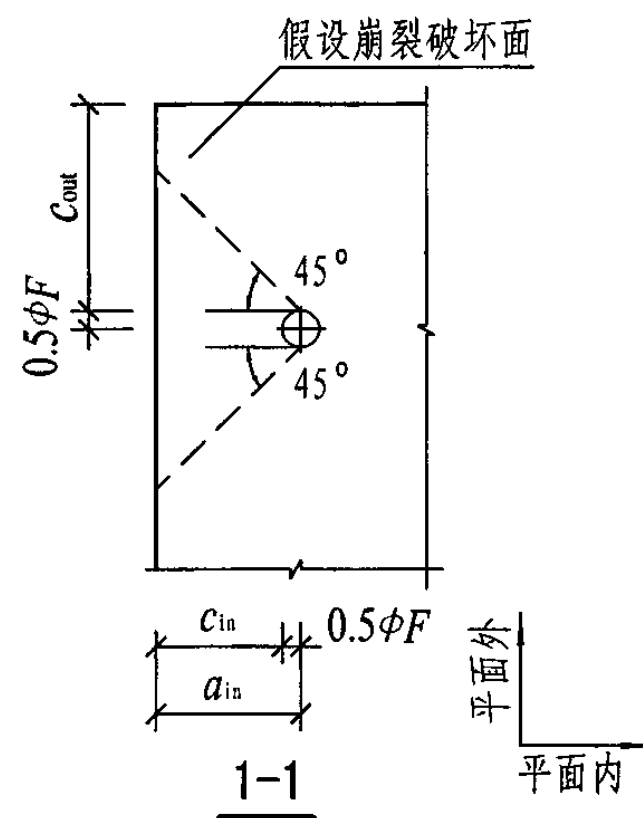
平面内抗崩裂钢筋的布置范围
